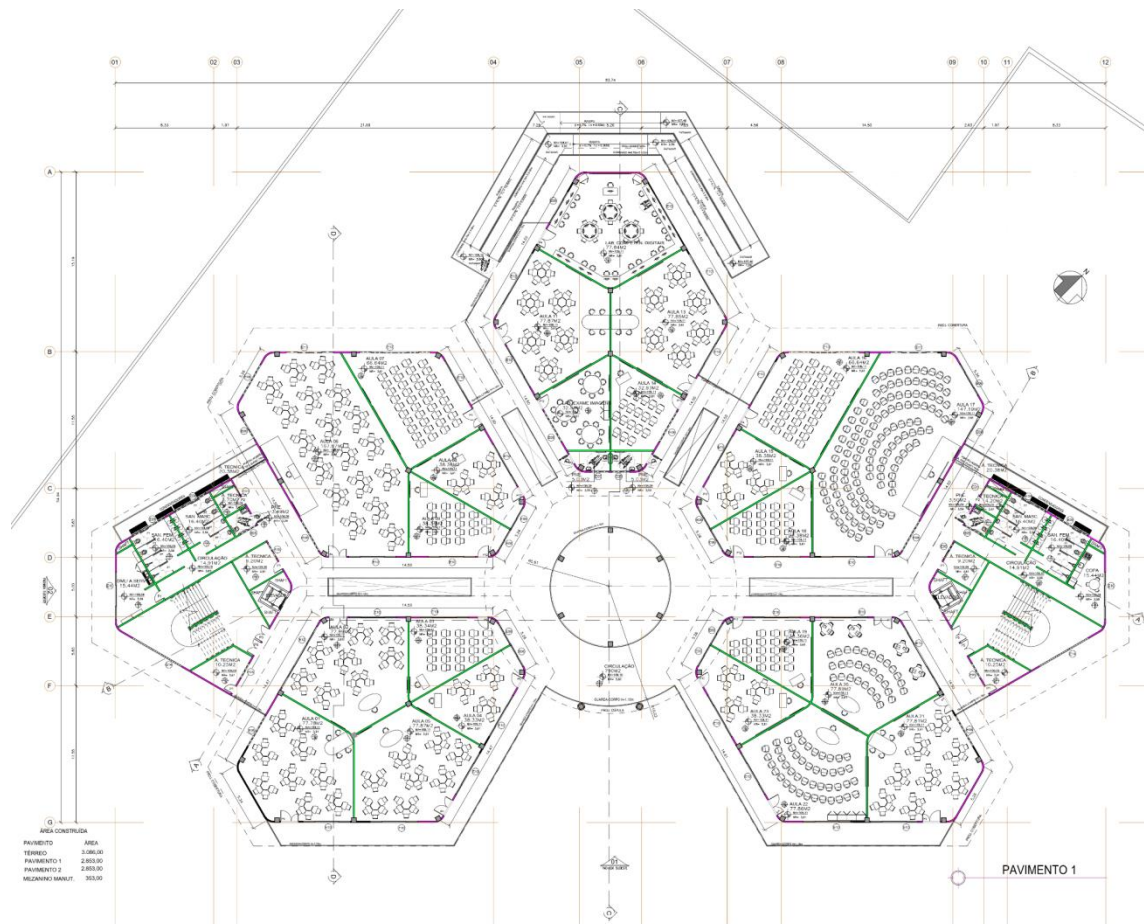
Planta do Primeiro Andar do Núcleo Pedagógico
